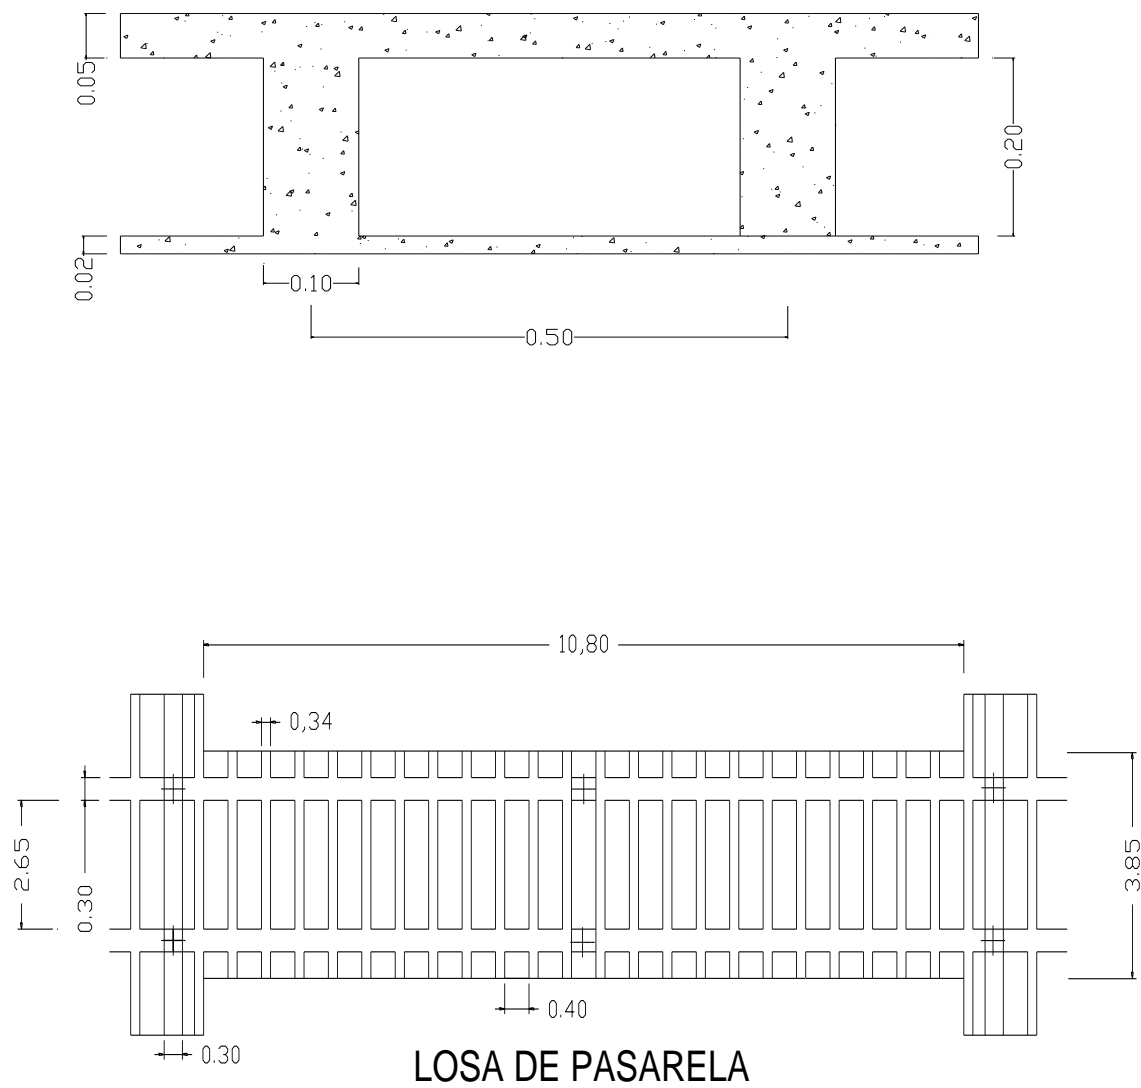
Corte Transversal y Vista de Planta de la Losa de Pasarela
